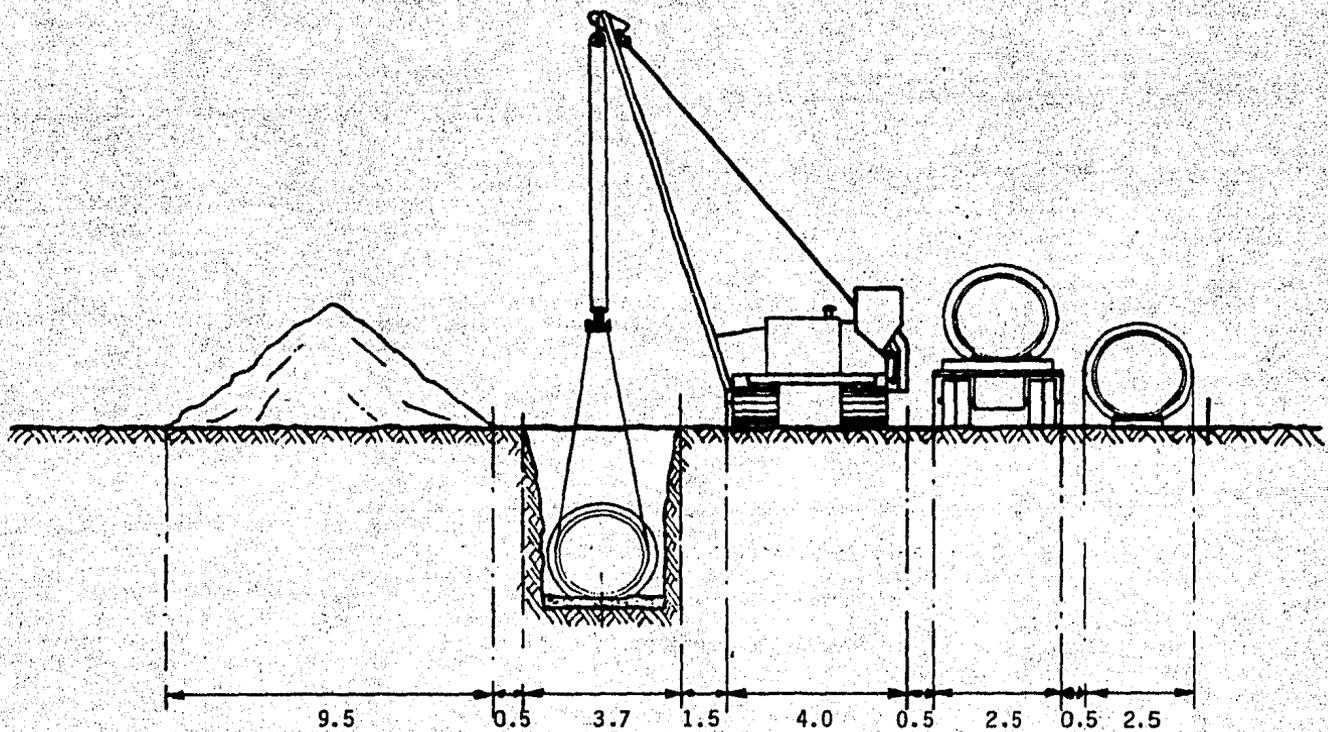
Sección constructiva para tubería \varnothing 1.80 m.
